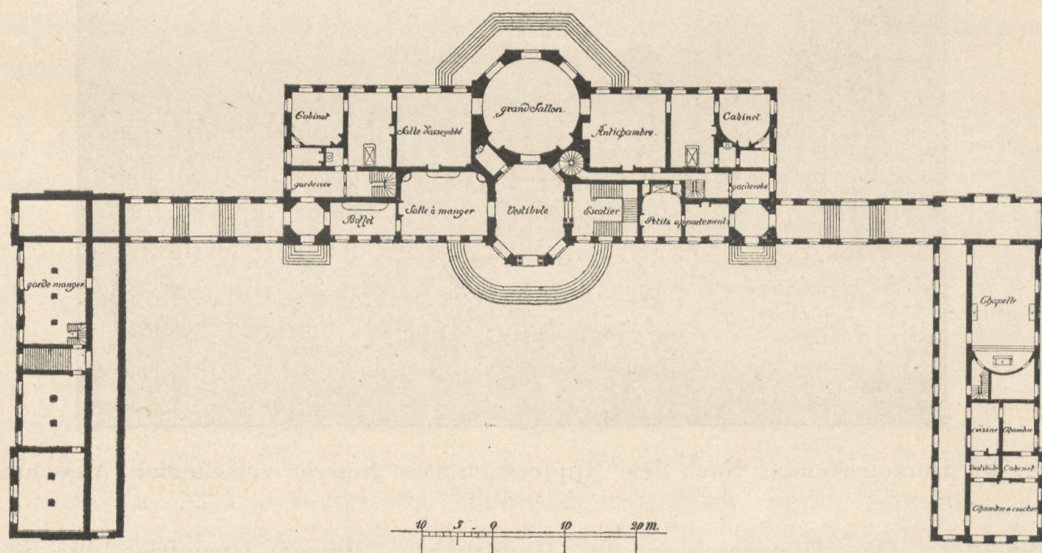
Jagdschloss Herzogsfreude, Grundriss (nach dem in der Kreis-Bibliothek in Bonn befindlichen Original-Grundriss).
